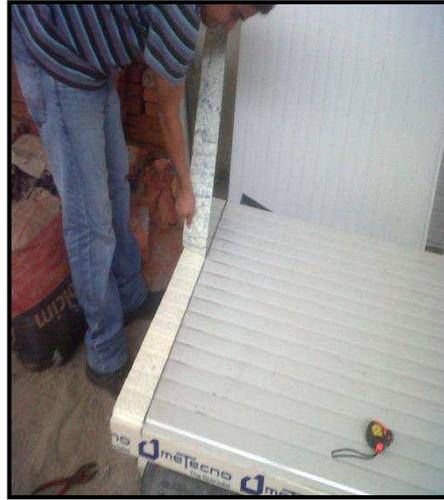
Colocación de las panchas sobre el muro de ladrillo.
